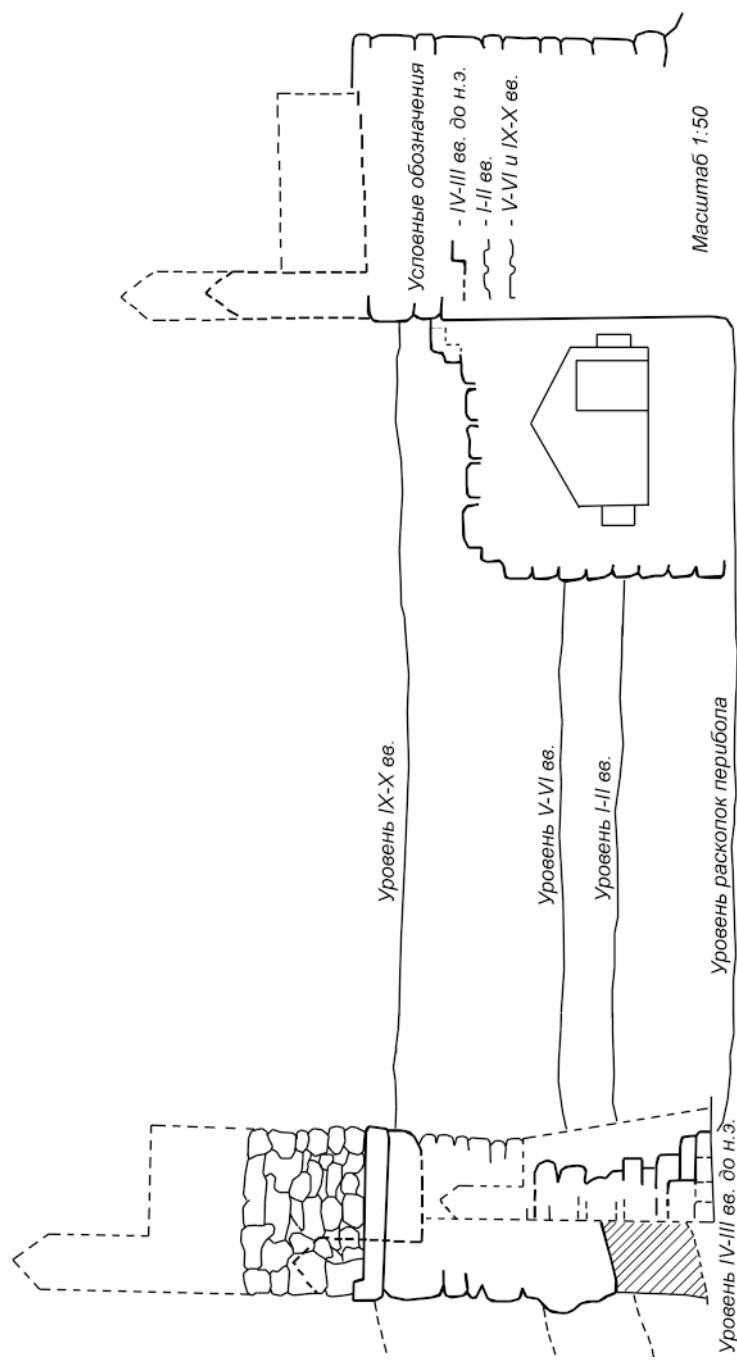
Схема повышения стены в связи с насыпями в балке.
